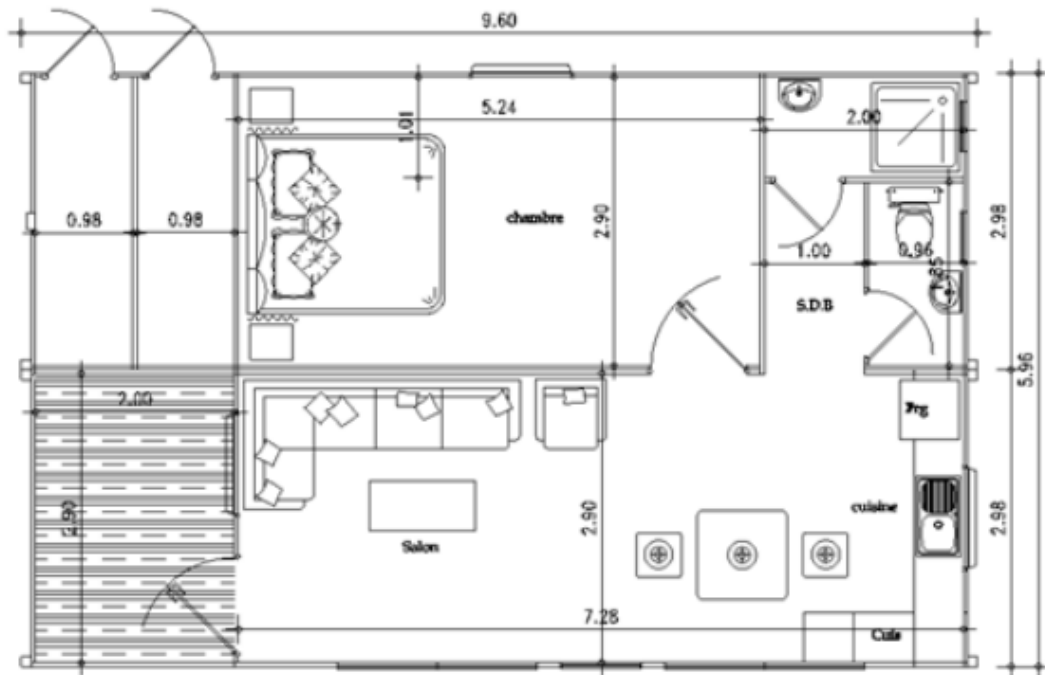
Plan architecturale de la maison solaire UDES.
